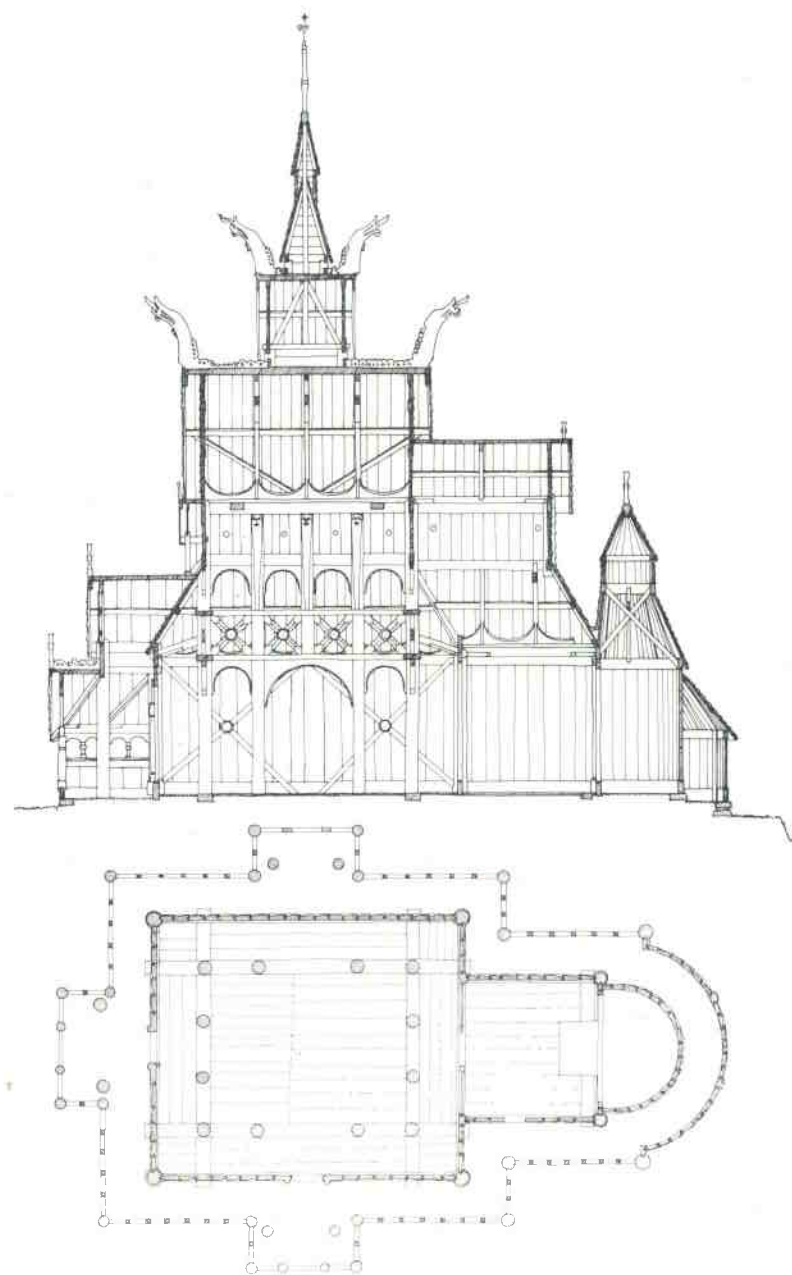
Borgund stavkirke. Langsnitt og grunnplan.
